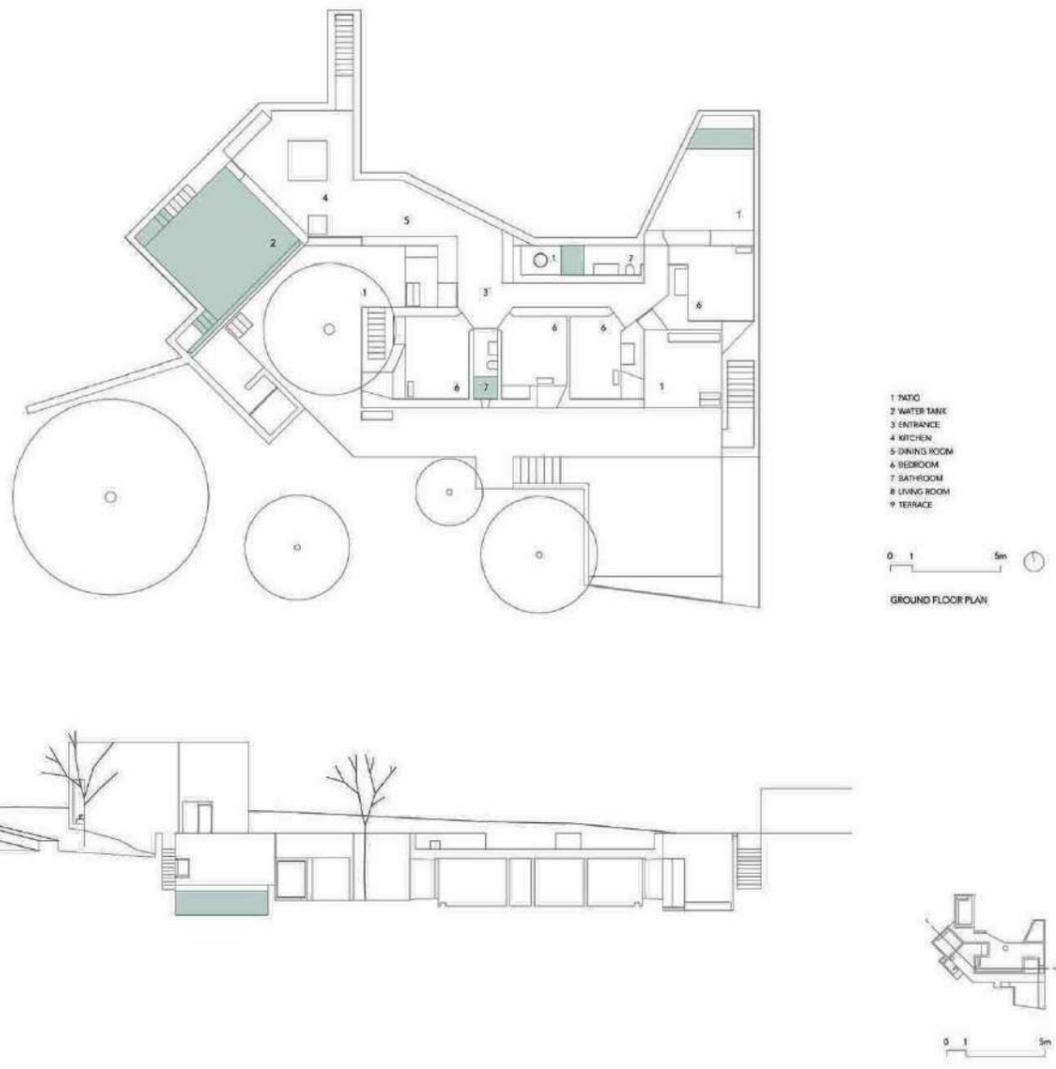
Casa Luum, acesso exterior para a cozinha - Planta do piso 0 - Corte-alçado que explica a relação entre os pisos
